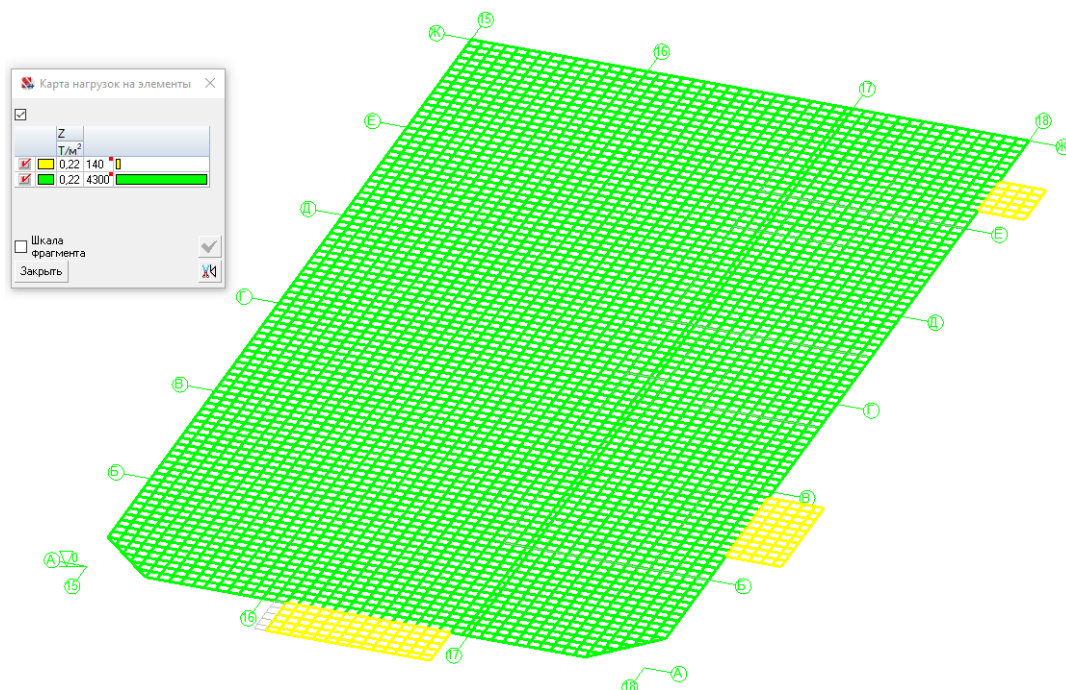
Загрузка плиты перекрытия нагрузкой от полов
